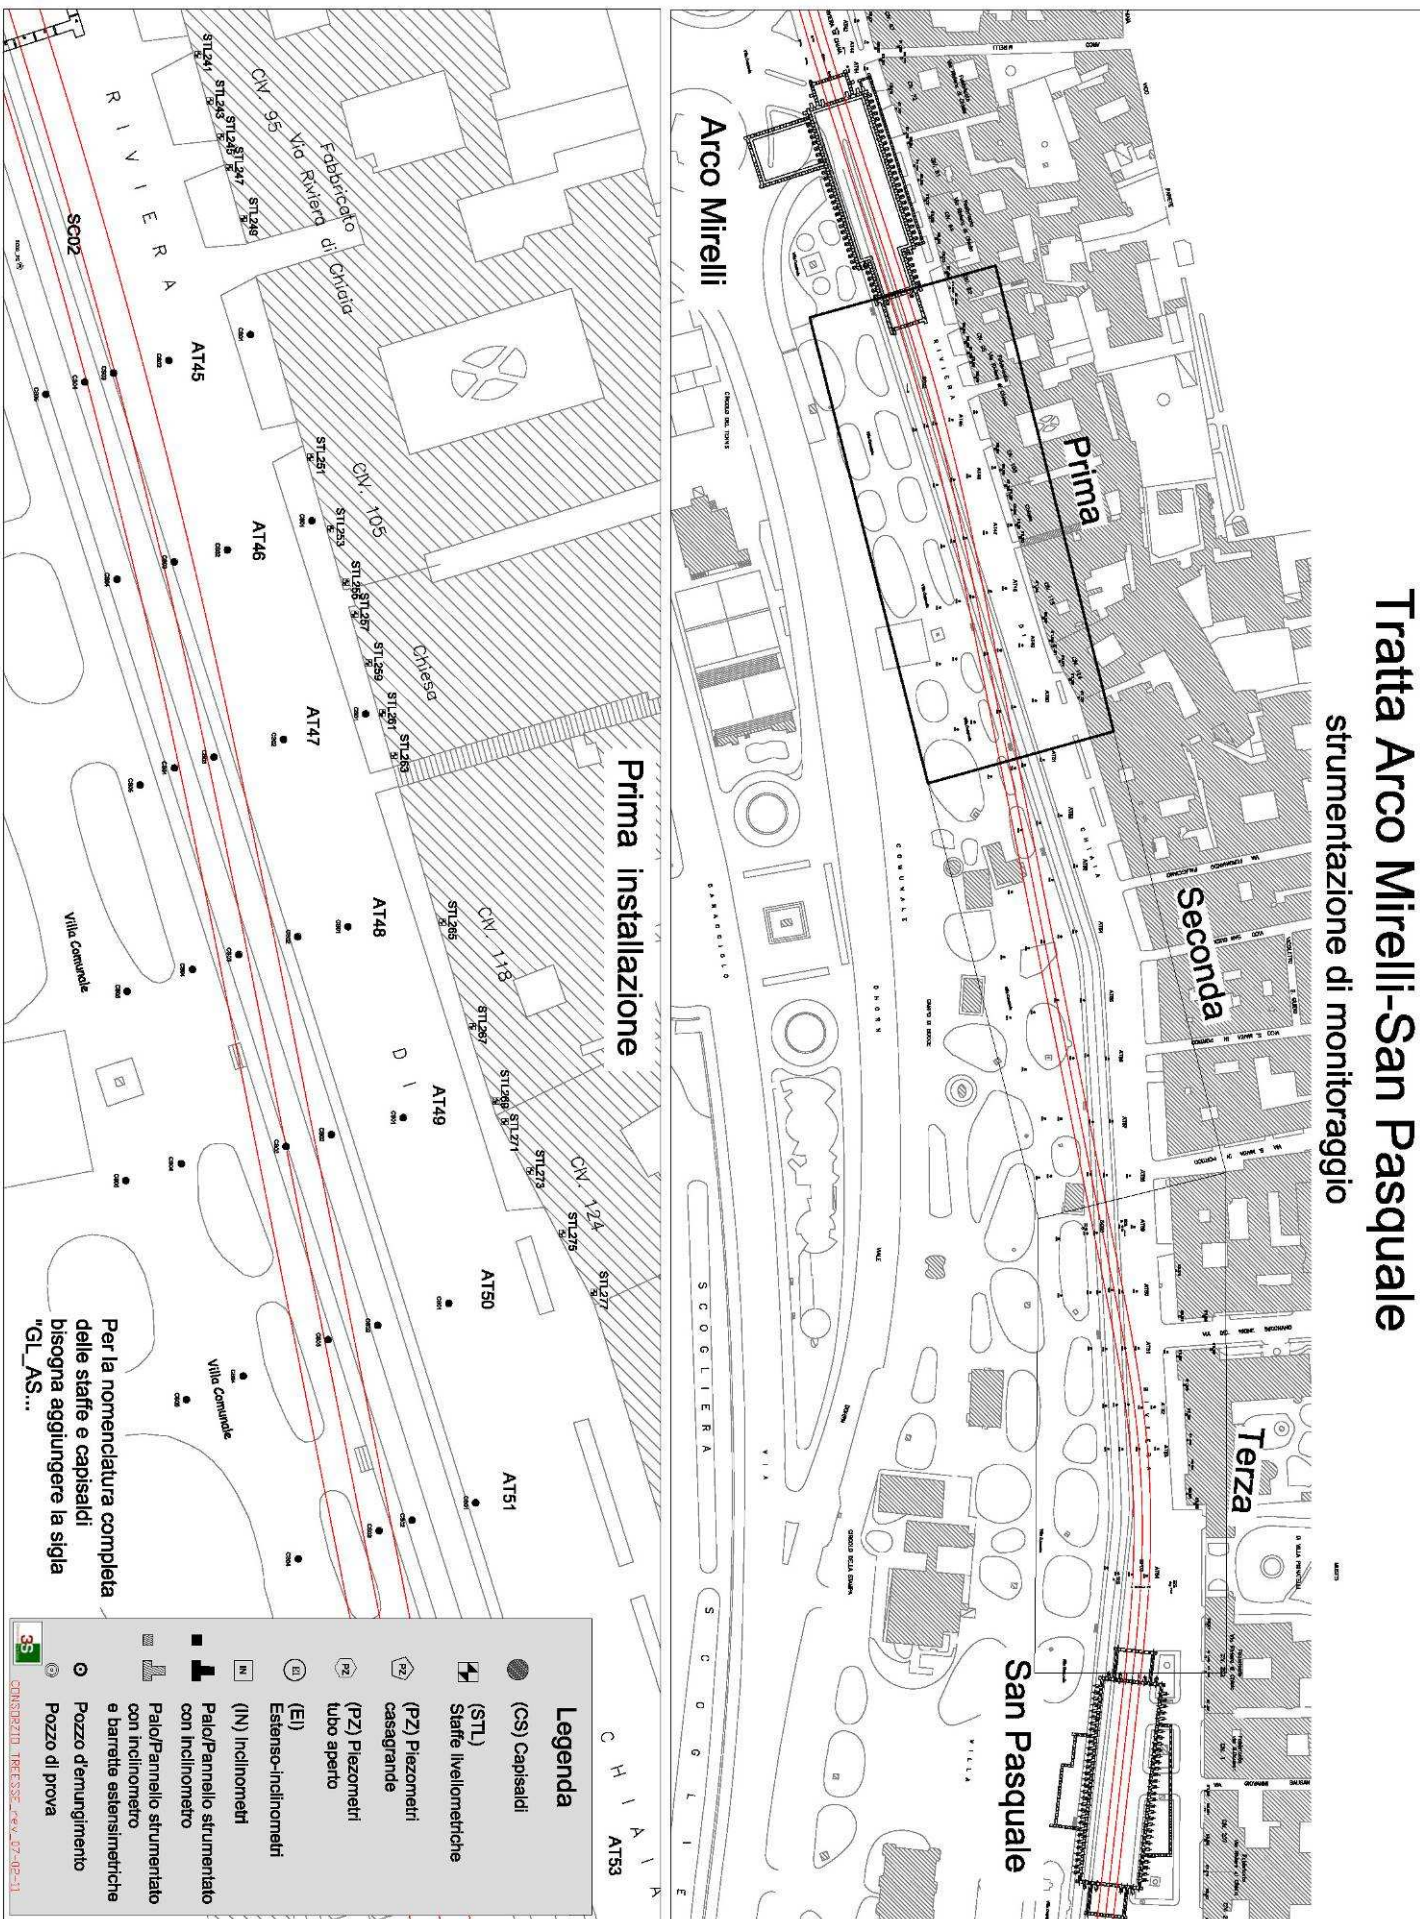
Planimetria tratta Arco Mirelli-San Pasquale, raffigurante la disposizione della prima installazione della strumentazione di monitoraggio.
